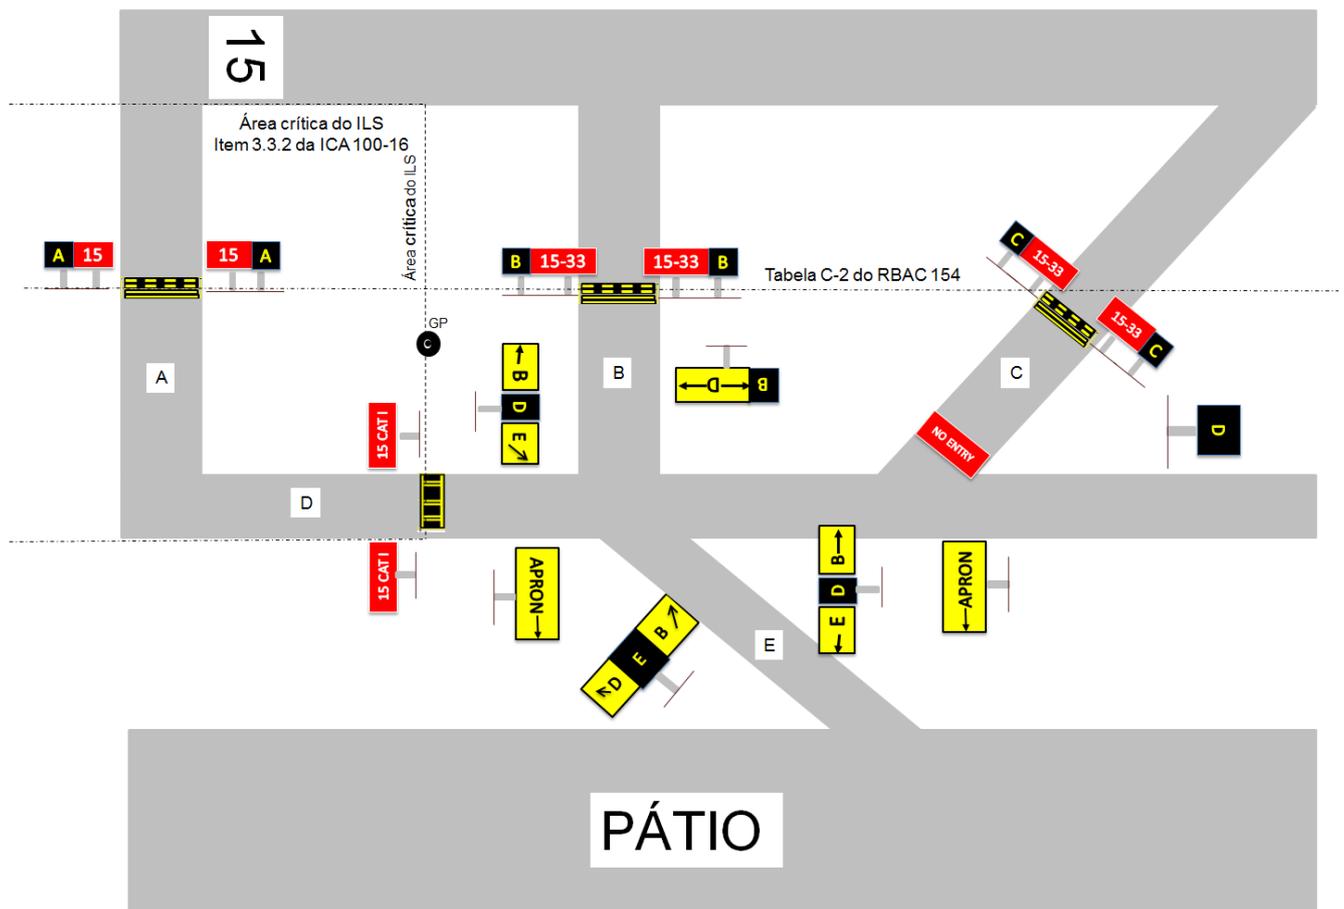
Configuração de sinalizações verticais (Fonte AC 150/5340-18F)
